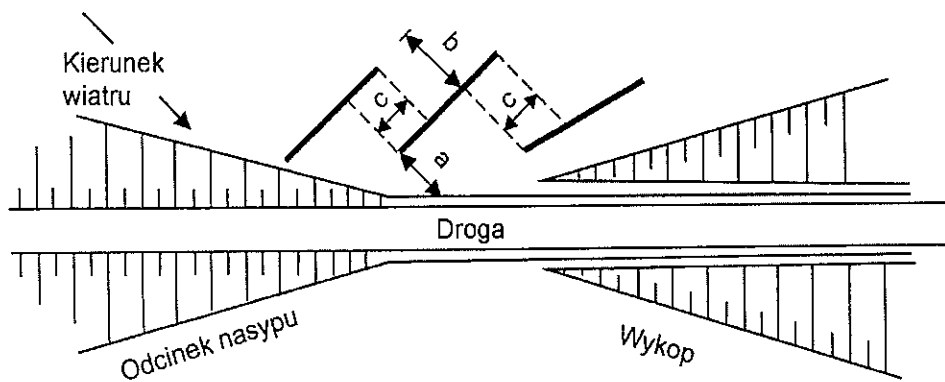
Ustawianie zasłon przy kierunku wiatru pokrywającym się z kierunkiem drogi
